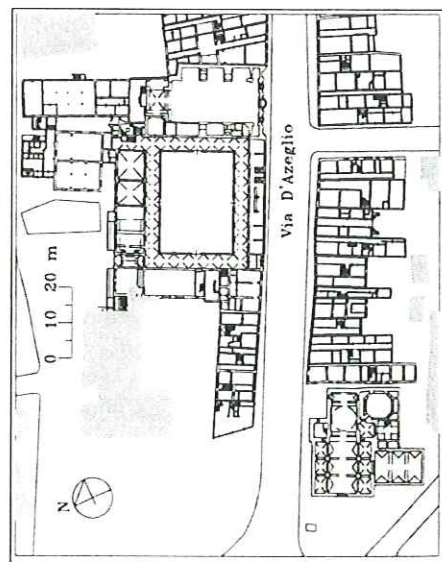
La rappresentazione planimetrica tradizionale di via D'Azeglio in Parma.
